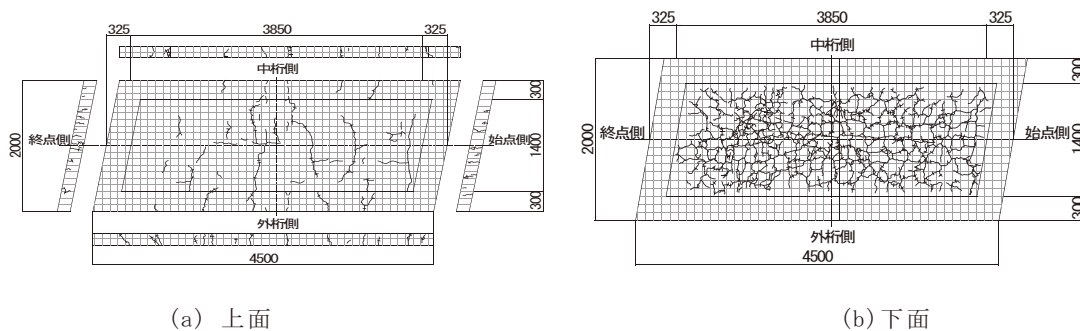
試験後(20万回走行)床版ひび割れ図
